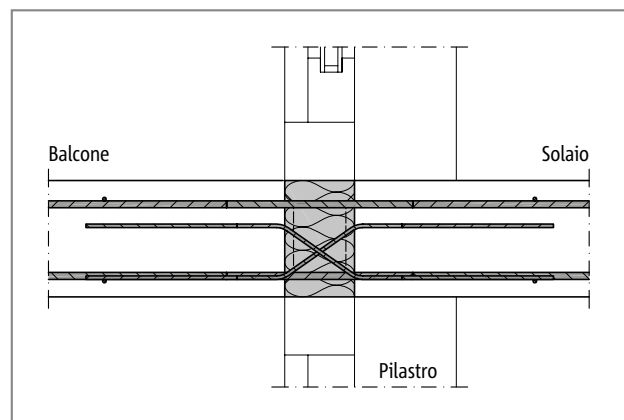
Schöck Isokorb® tipo DXT: sezione costruttiva; solaio piano
